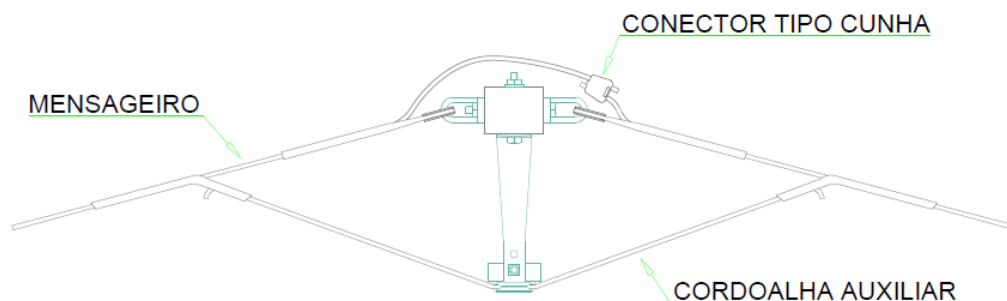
Amarrações e Ancoragens – Cordoalha Auxiliar – Cabo Mensageiro
